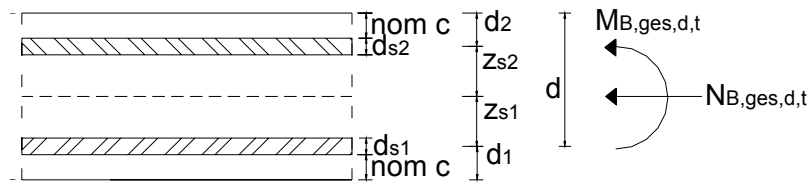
Längsschnitt durch die Betonplatte mit Zug- und Druckbewehrung (Fall 3)
